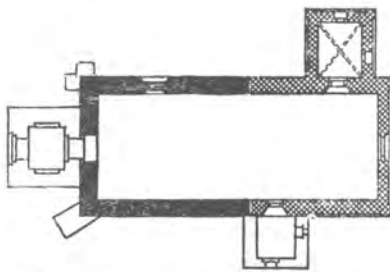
Liepen; Pfarrkirche, Grundriss. 1:500.
